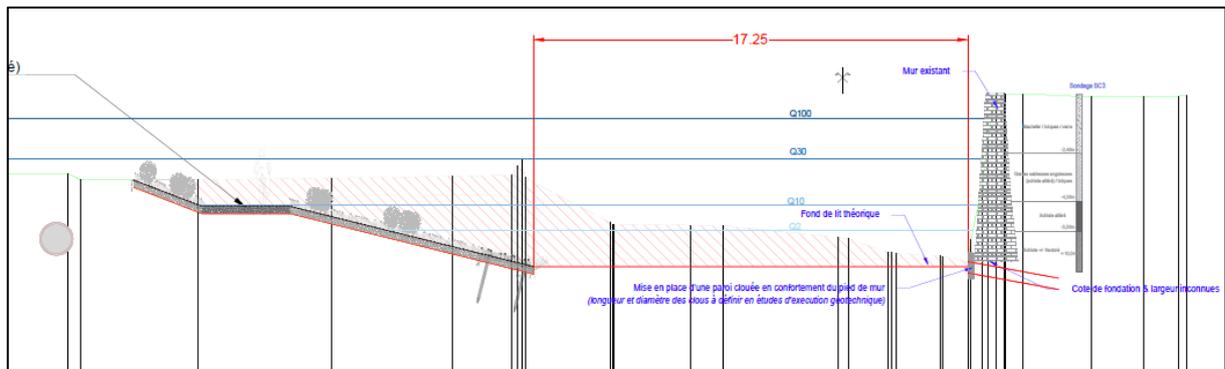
Coupe de principe de la protection du mur aval rive droite
